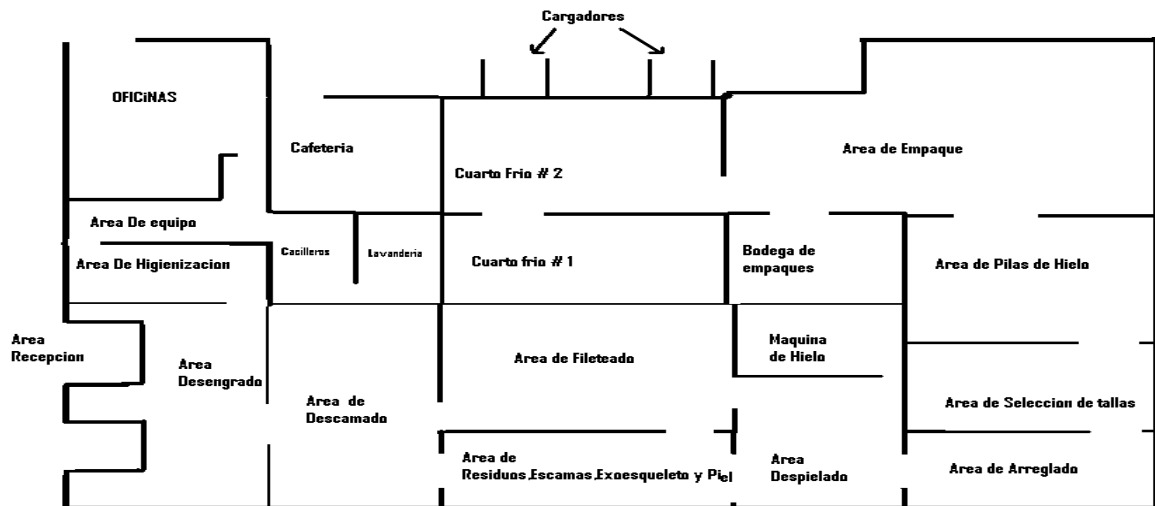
Muestra el Diseño de la Planta Procesadora de Tilapia
